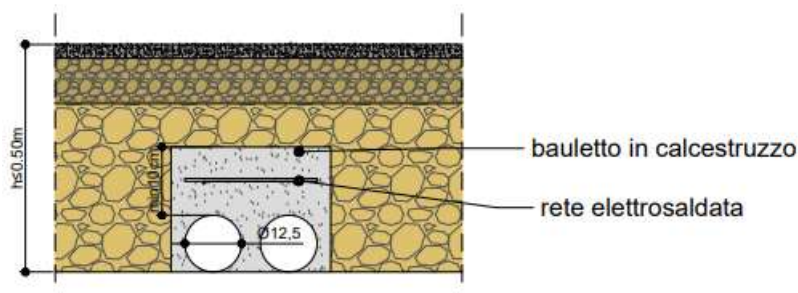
bauletto in cls di protezione dei cavi nel tratto in corrispondenza della galleria ferroviaria
